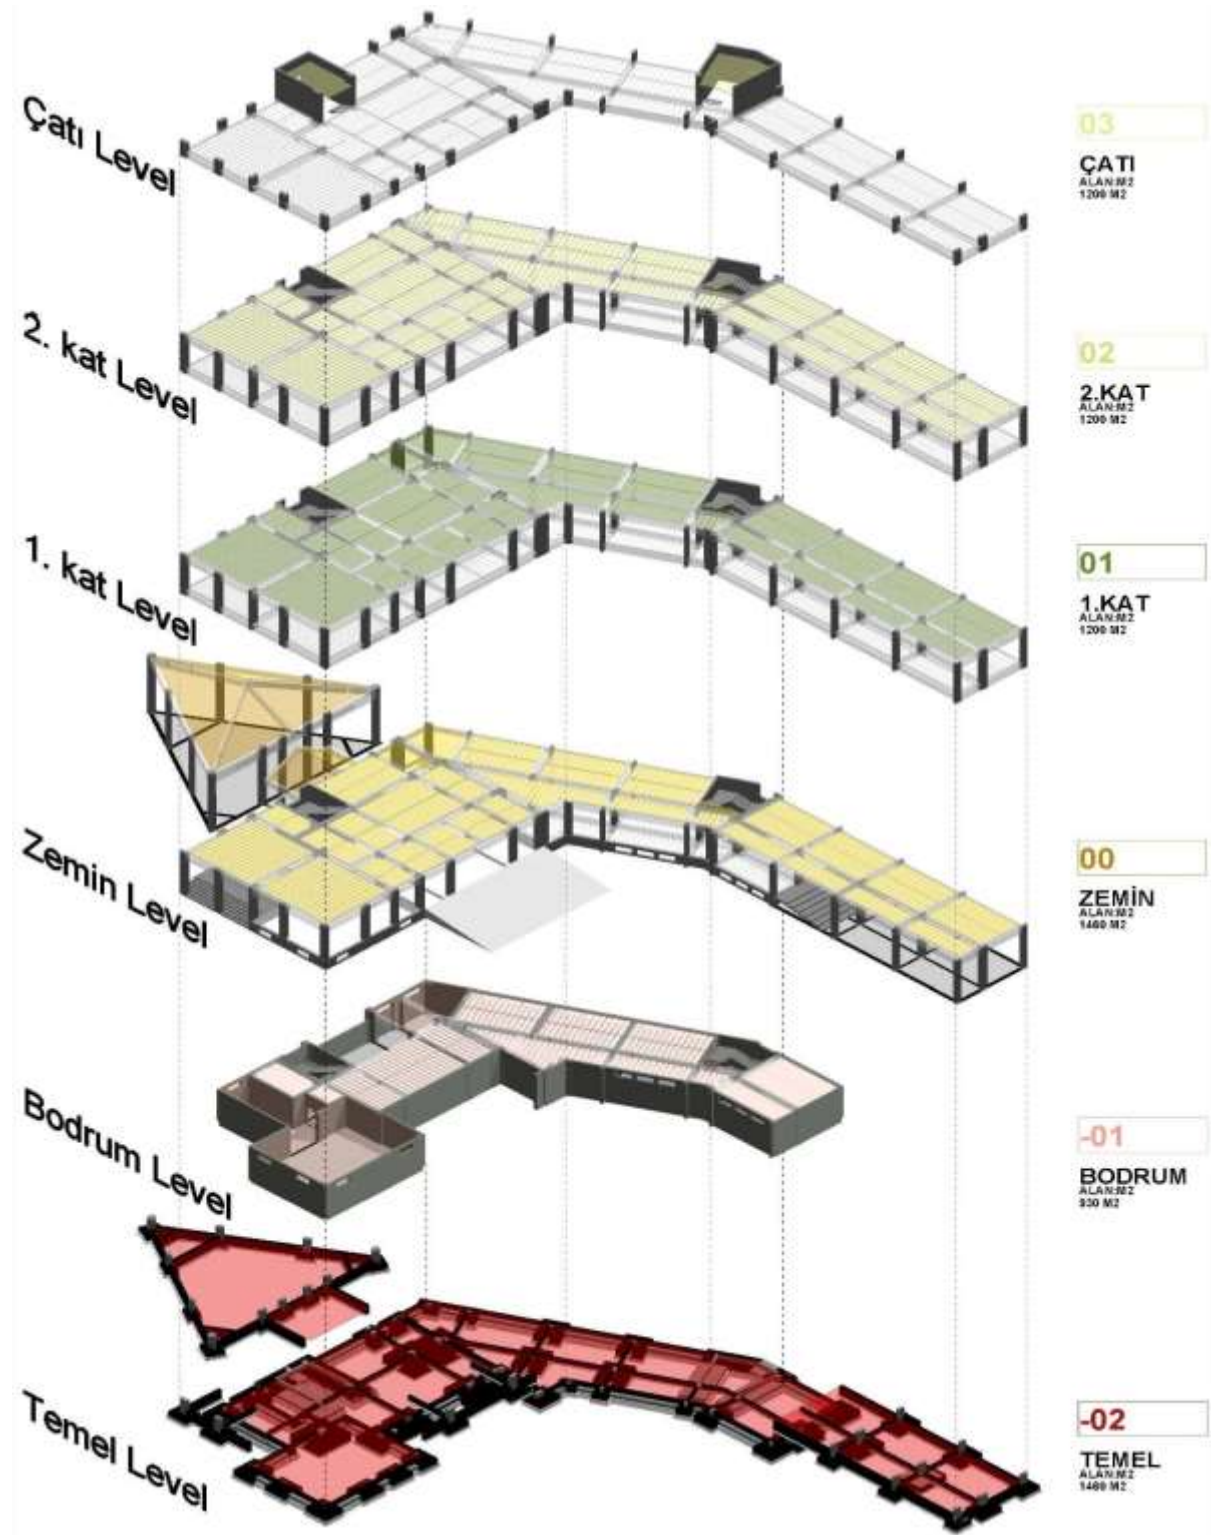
3D modeline ait genel plan görüntüsü.
